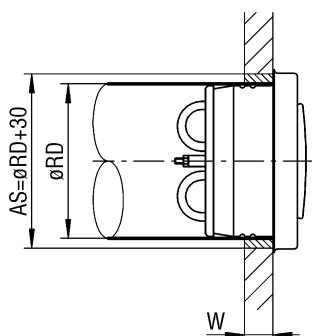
montaggio con colata sul soffitto del canale di ventilazione
